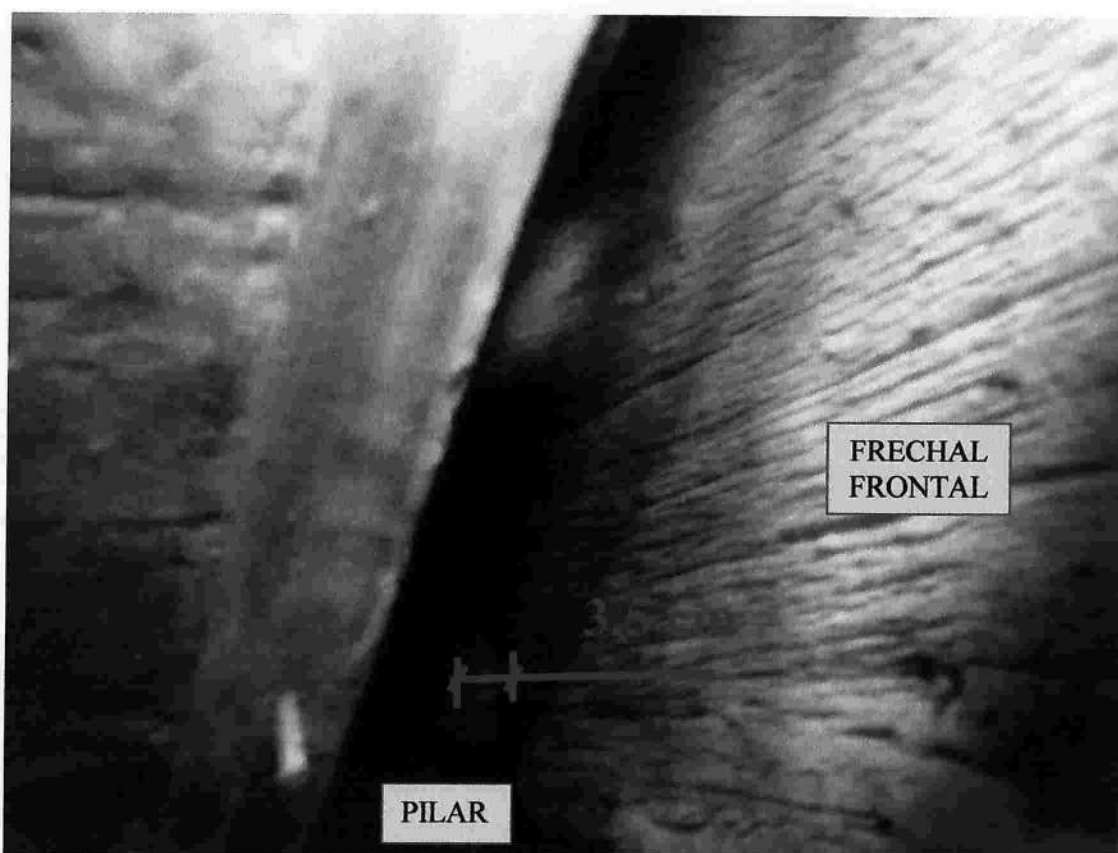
O comprometimento da ligação entre o pilar e o frecha frontal, aliado à ação das componentes horizontais das cargas da cobertura provocaram um deslocamento de, aproximadamente, 3,5 cm da cabeça pilar e da parede de adobe, na direção da fachada lateral direita, com o consequente trincamento e abaulamento da mesma.
